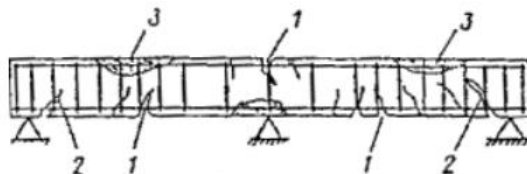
Характерные трещины в изгибаемых железобетонных элементах, работающих по балочной схеме.
